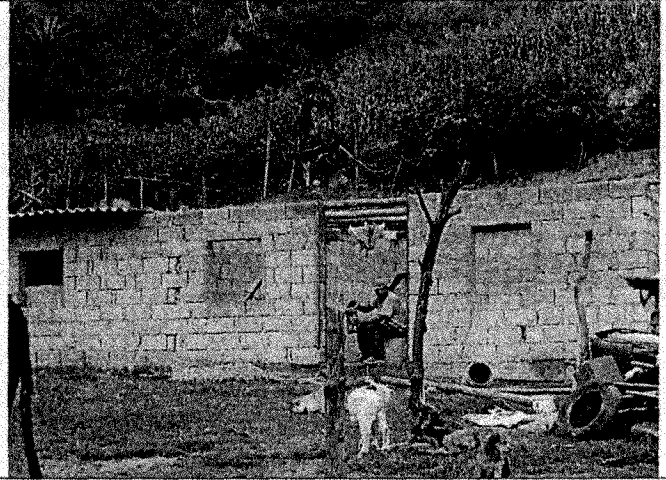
; Vista de proceso constructivo en el predio N° 1212603.
